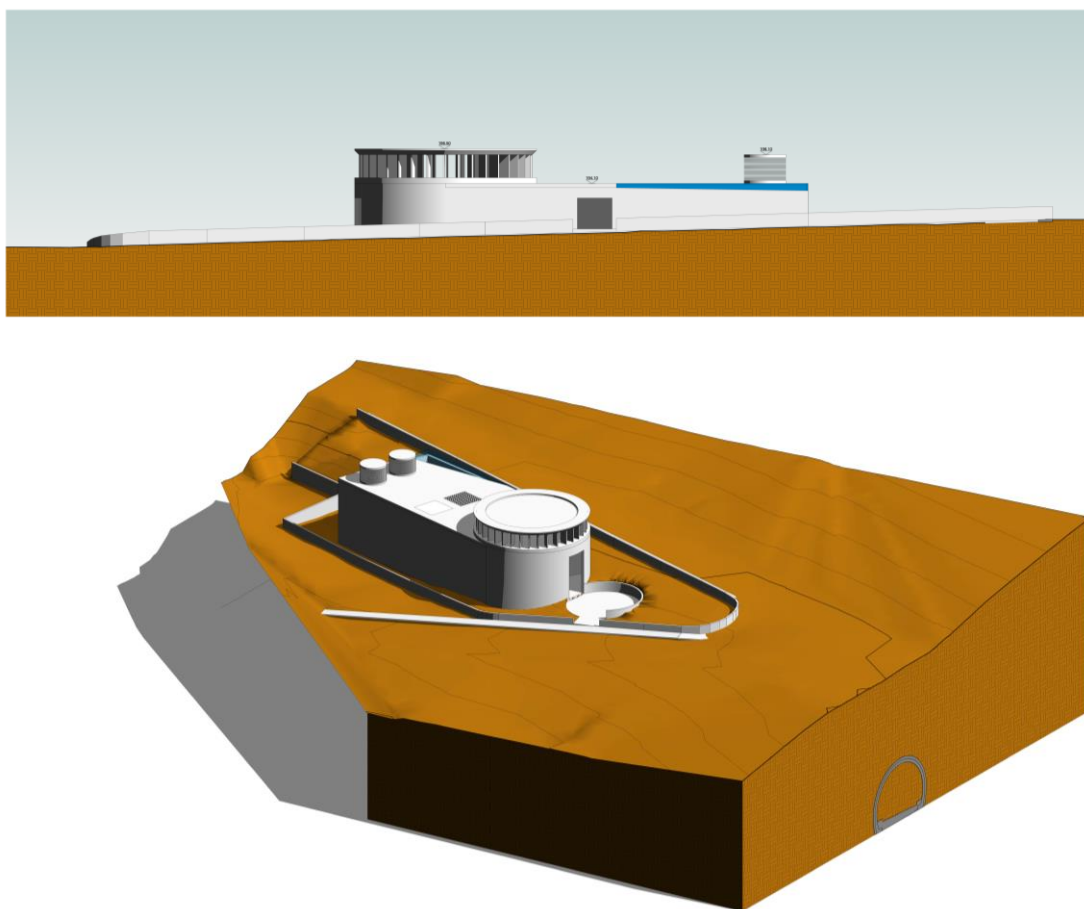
Modelo 3D do Poço de Ventilação e Emergência
